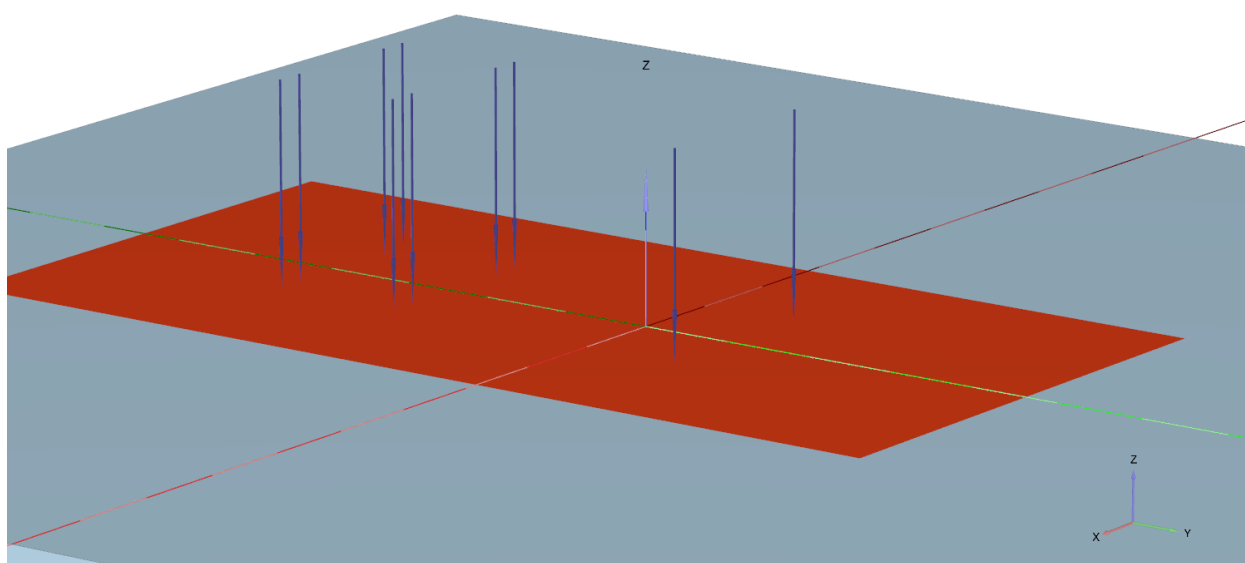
Расчетная схема приложения нагрузки от самосвала Камаз 6520 на плиты МДП
